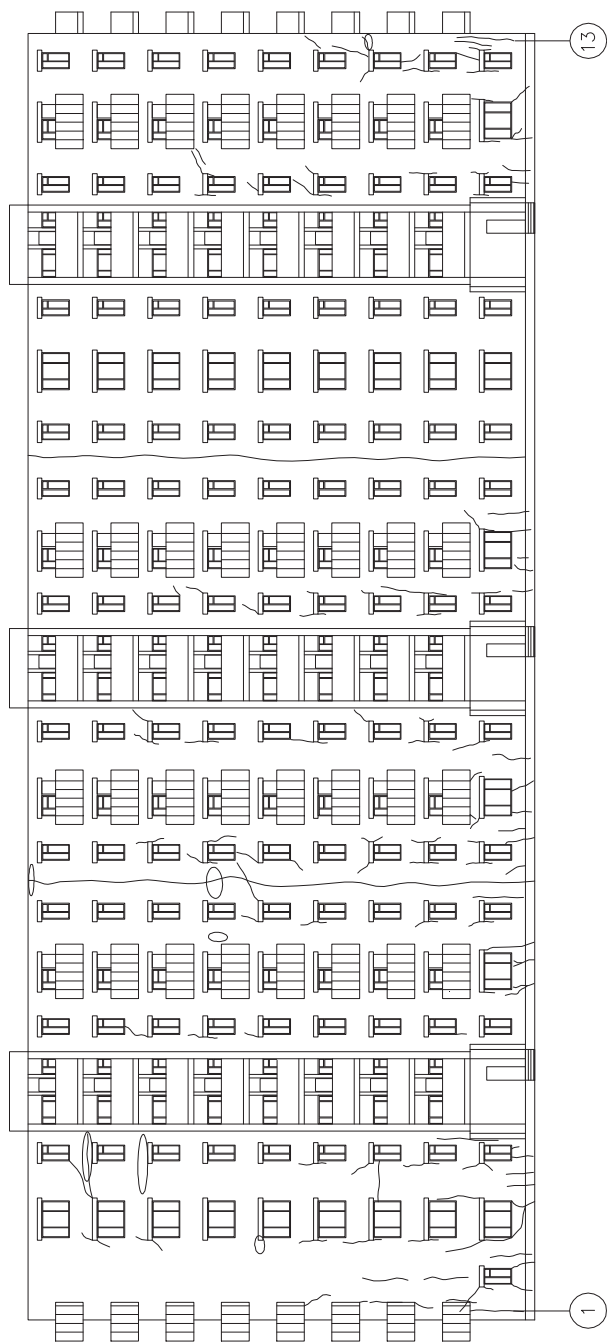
Карта дефектів по фасаді будівлі (вісь А)
